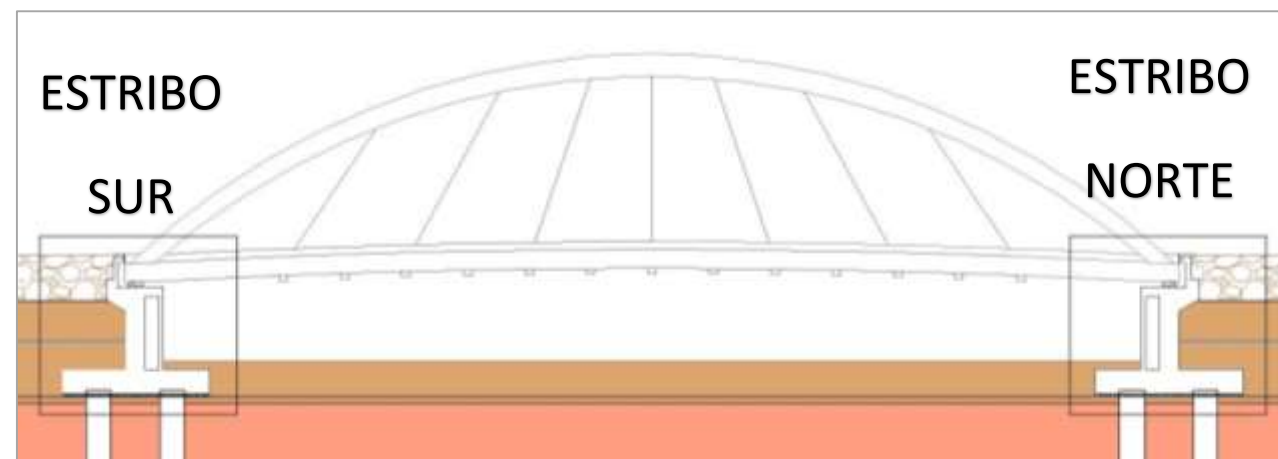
Localización de ambos estribos en el alzado de la estructura (vista desde el mar). Fuente: Elaboración propia sobre alzado de la estructura con AutoCAD.
